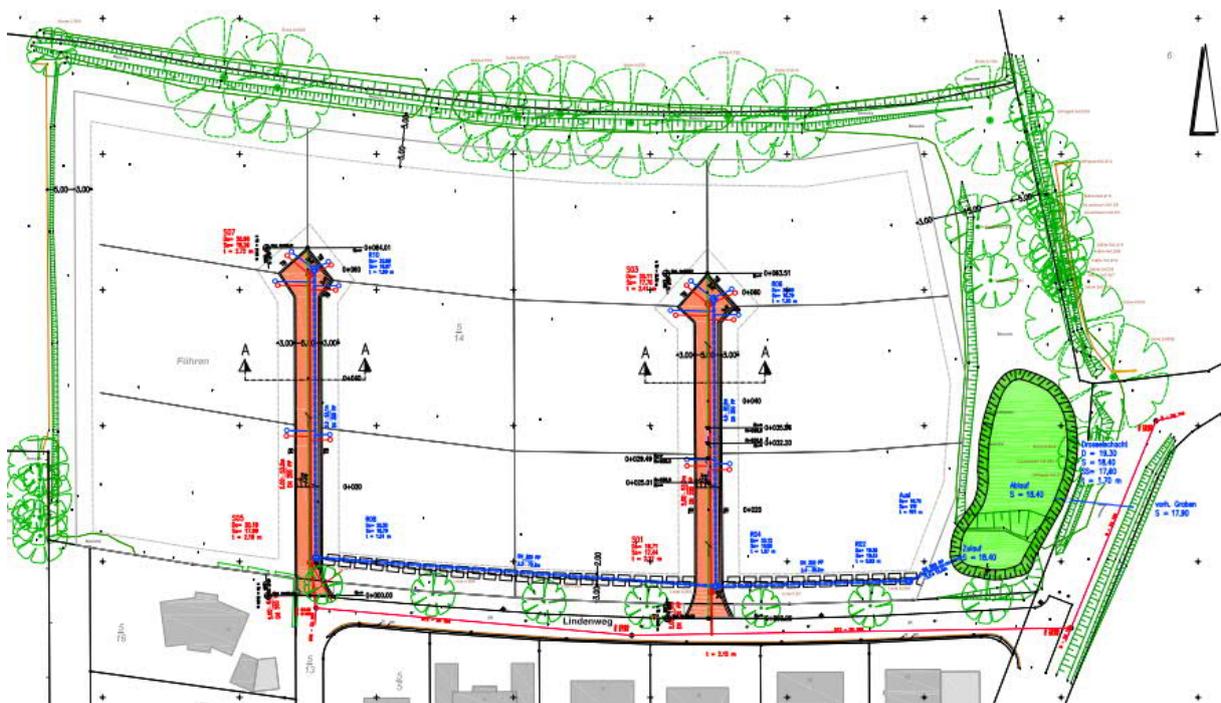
Lageplan Straßenbau und Entwässerung
